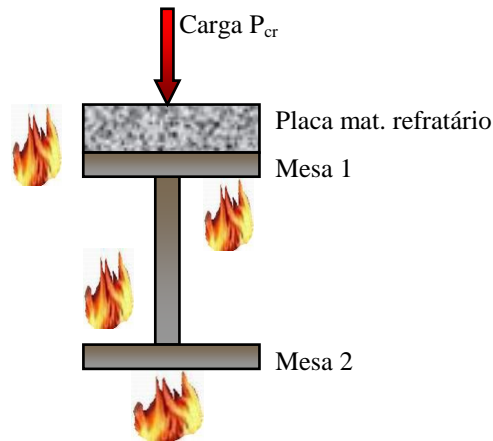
Viga em perfil metálico I em situação de incêndio.
